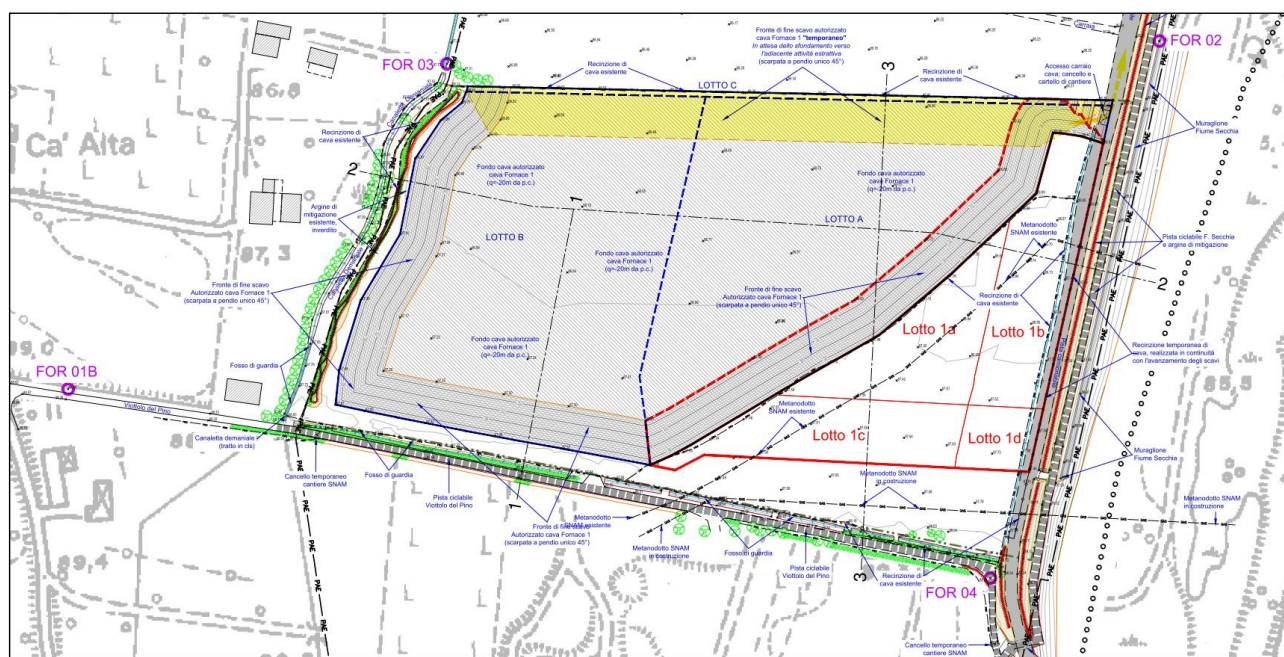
Stralcio Tav. 03 – Stato di Fatto "Planimetria dello stato Autorizzato - Fine scavo cava Fornace 1".
